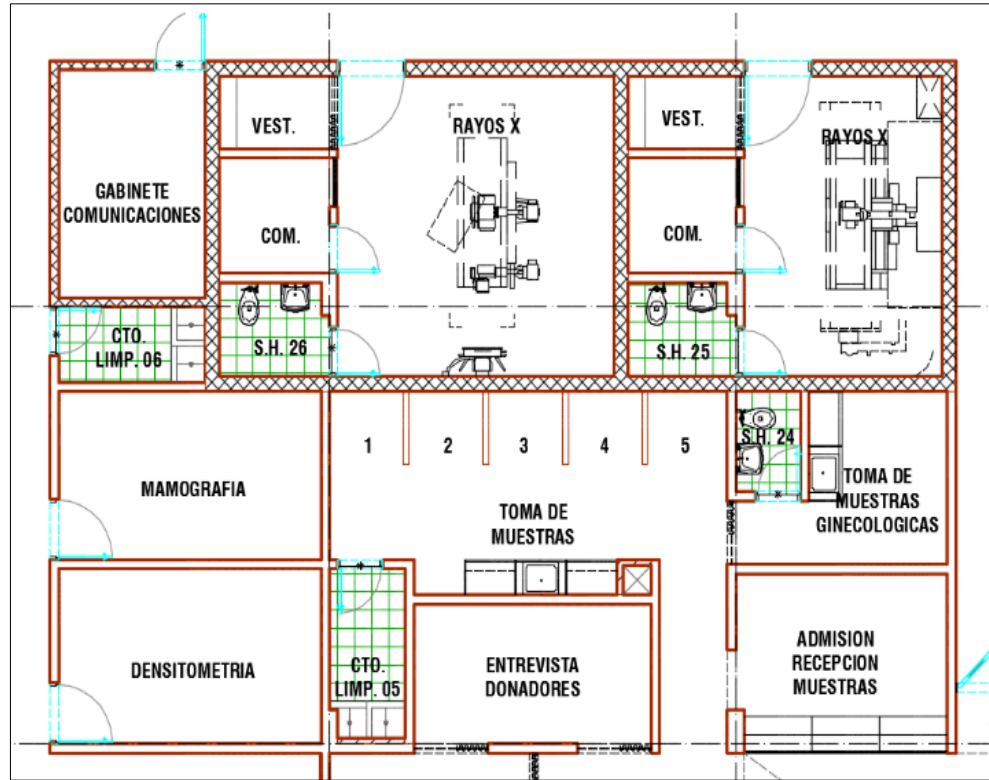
Plano de columnetas – Adicional de obra N°04.
